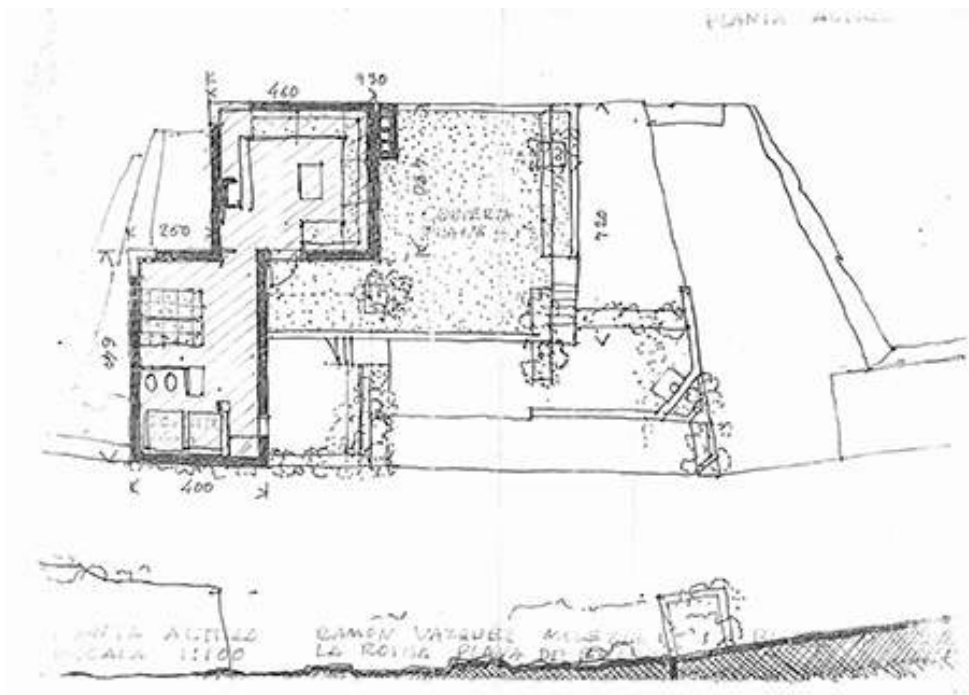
Molezún. La Roiba. Croquis de planta alta. Proyecto de ampliación. 1975
